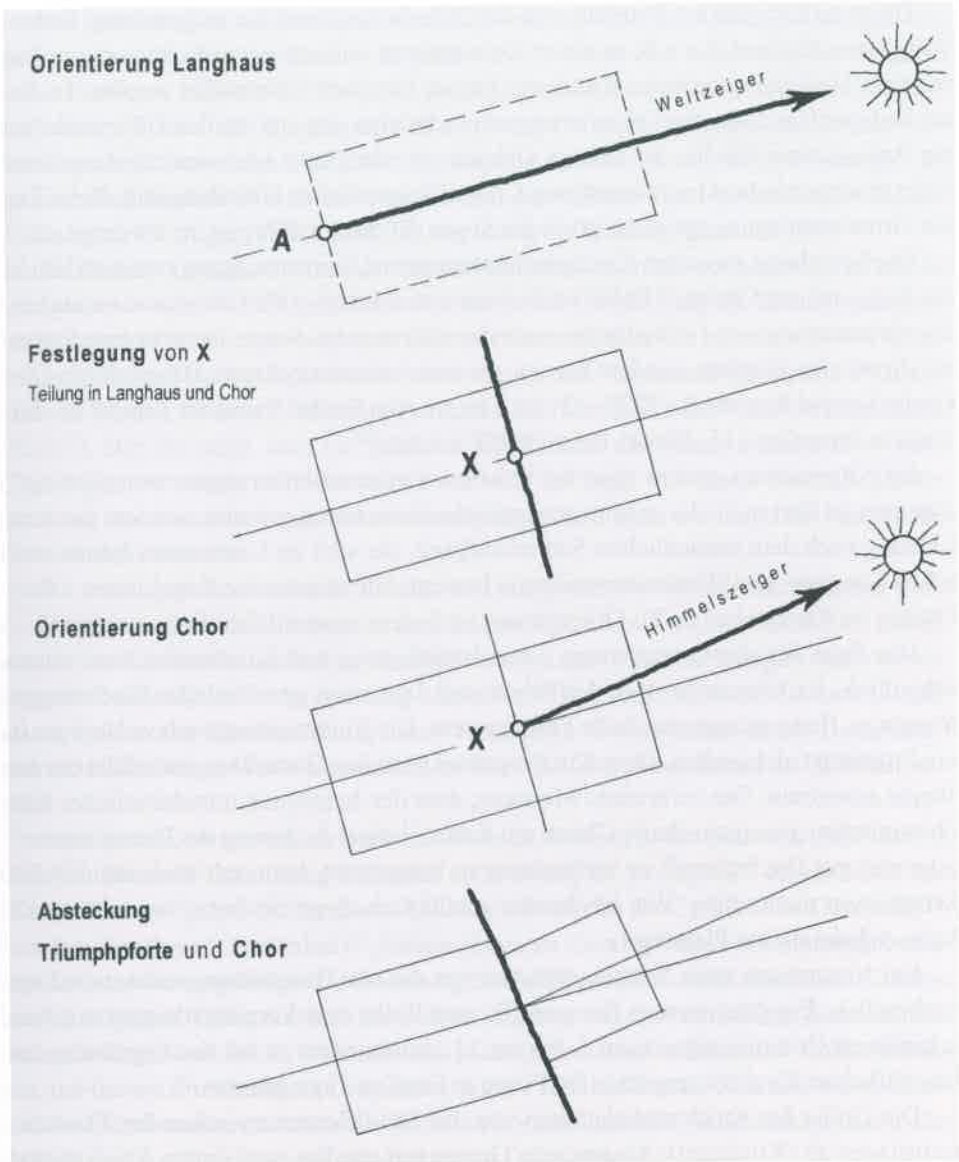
Orientierung und Absteckung eines Kirchengrundrisses mit Achsknick (Schema):
